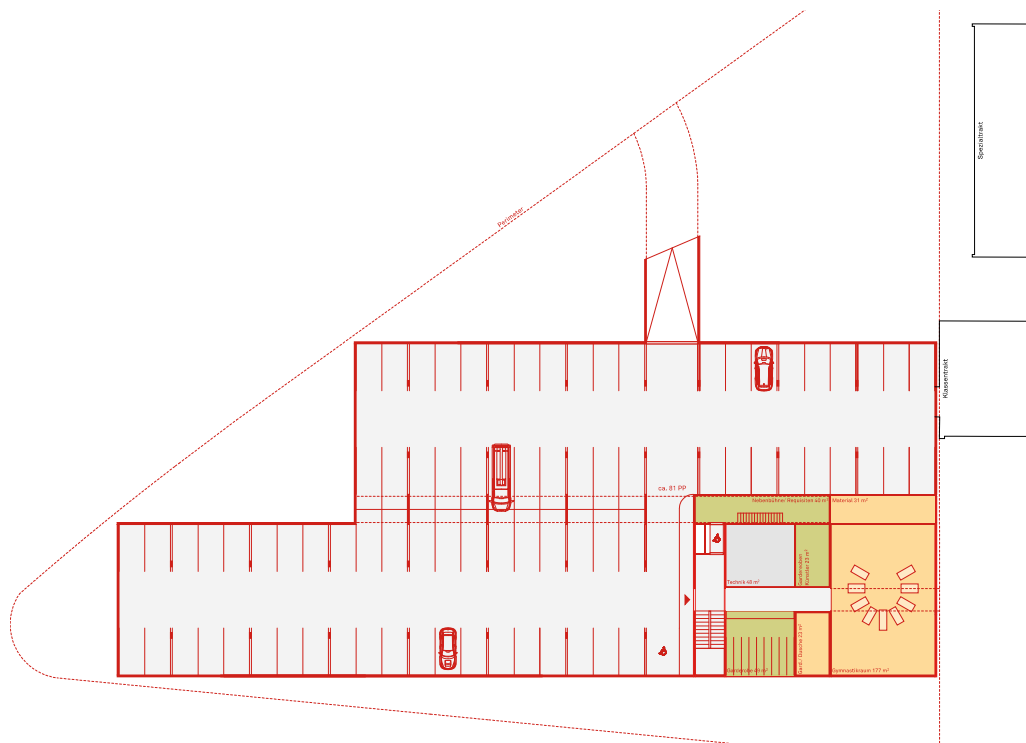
Untergeschoss mit Parkierung, Gymnastikraum, Garderoben und Technikräumen
